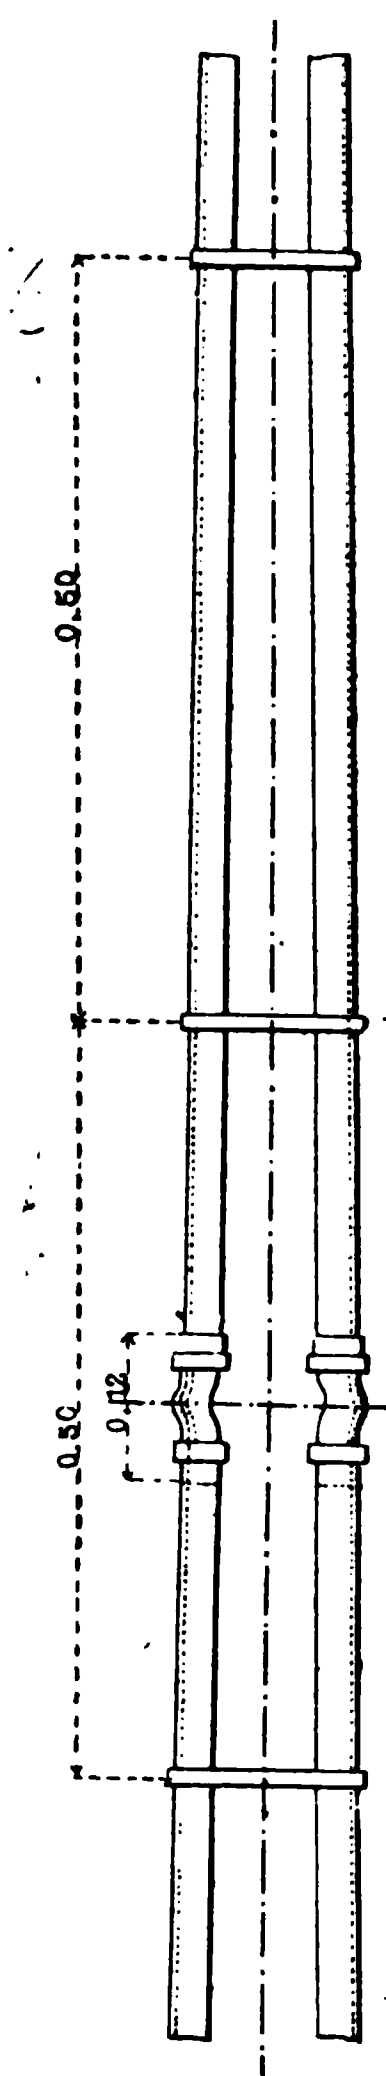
Assemblage de deux segments du poteau (Échelle 1/10).
